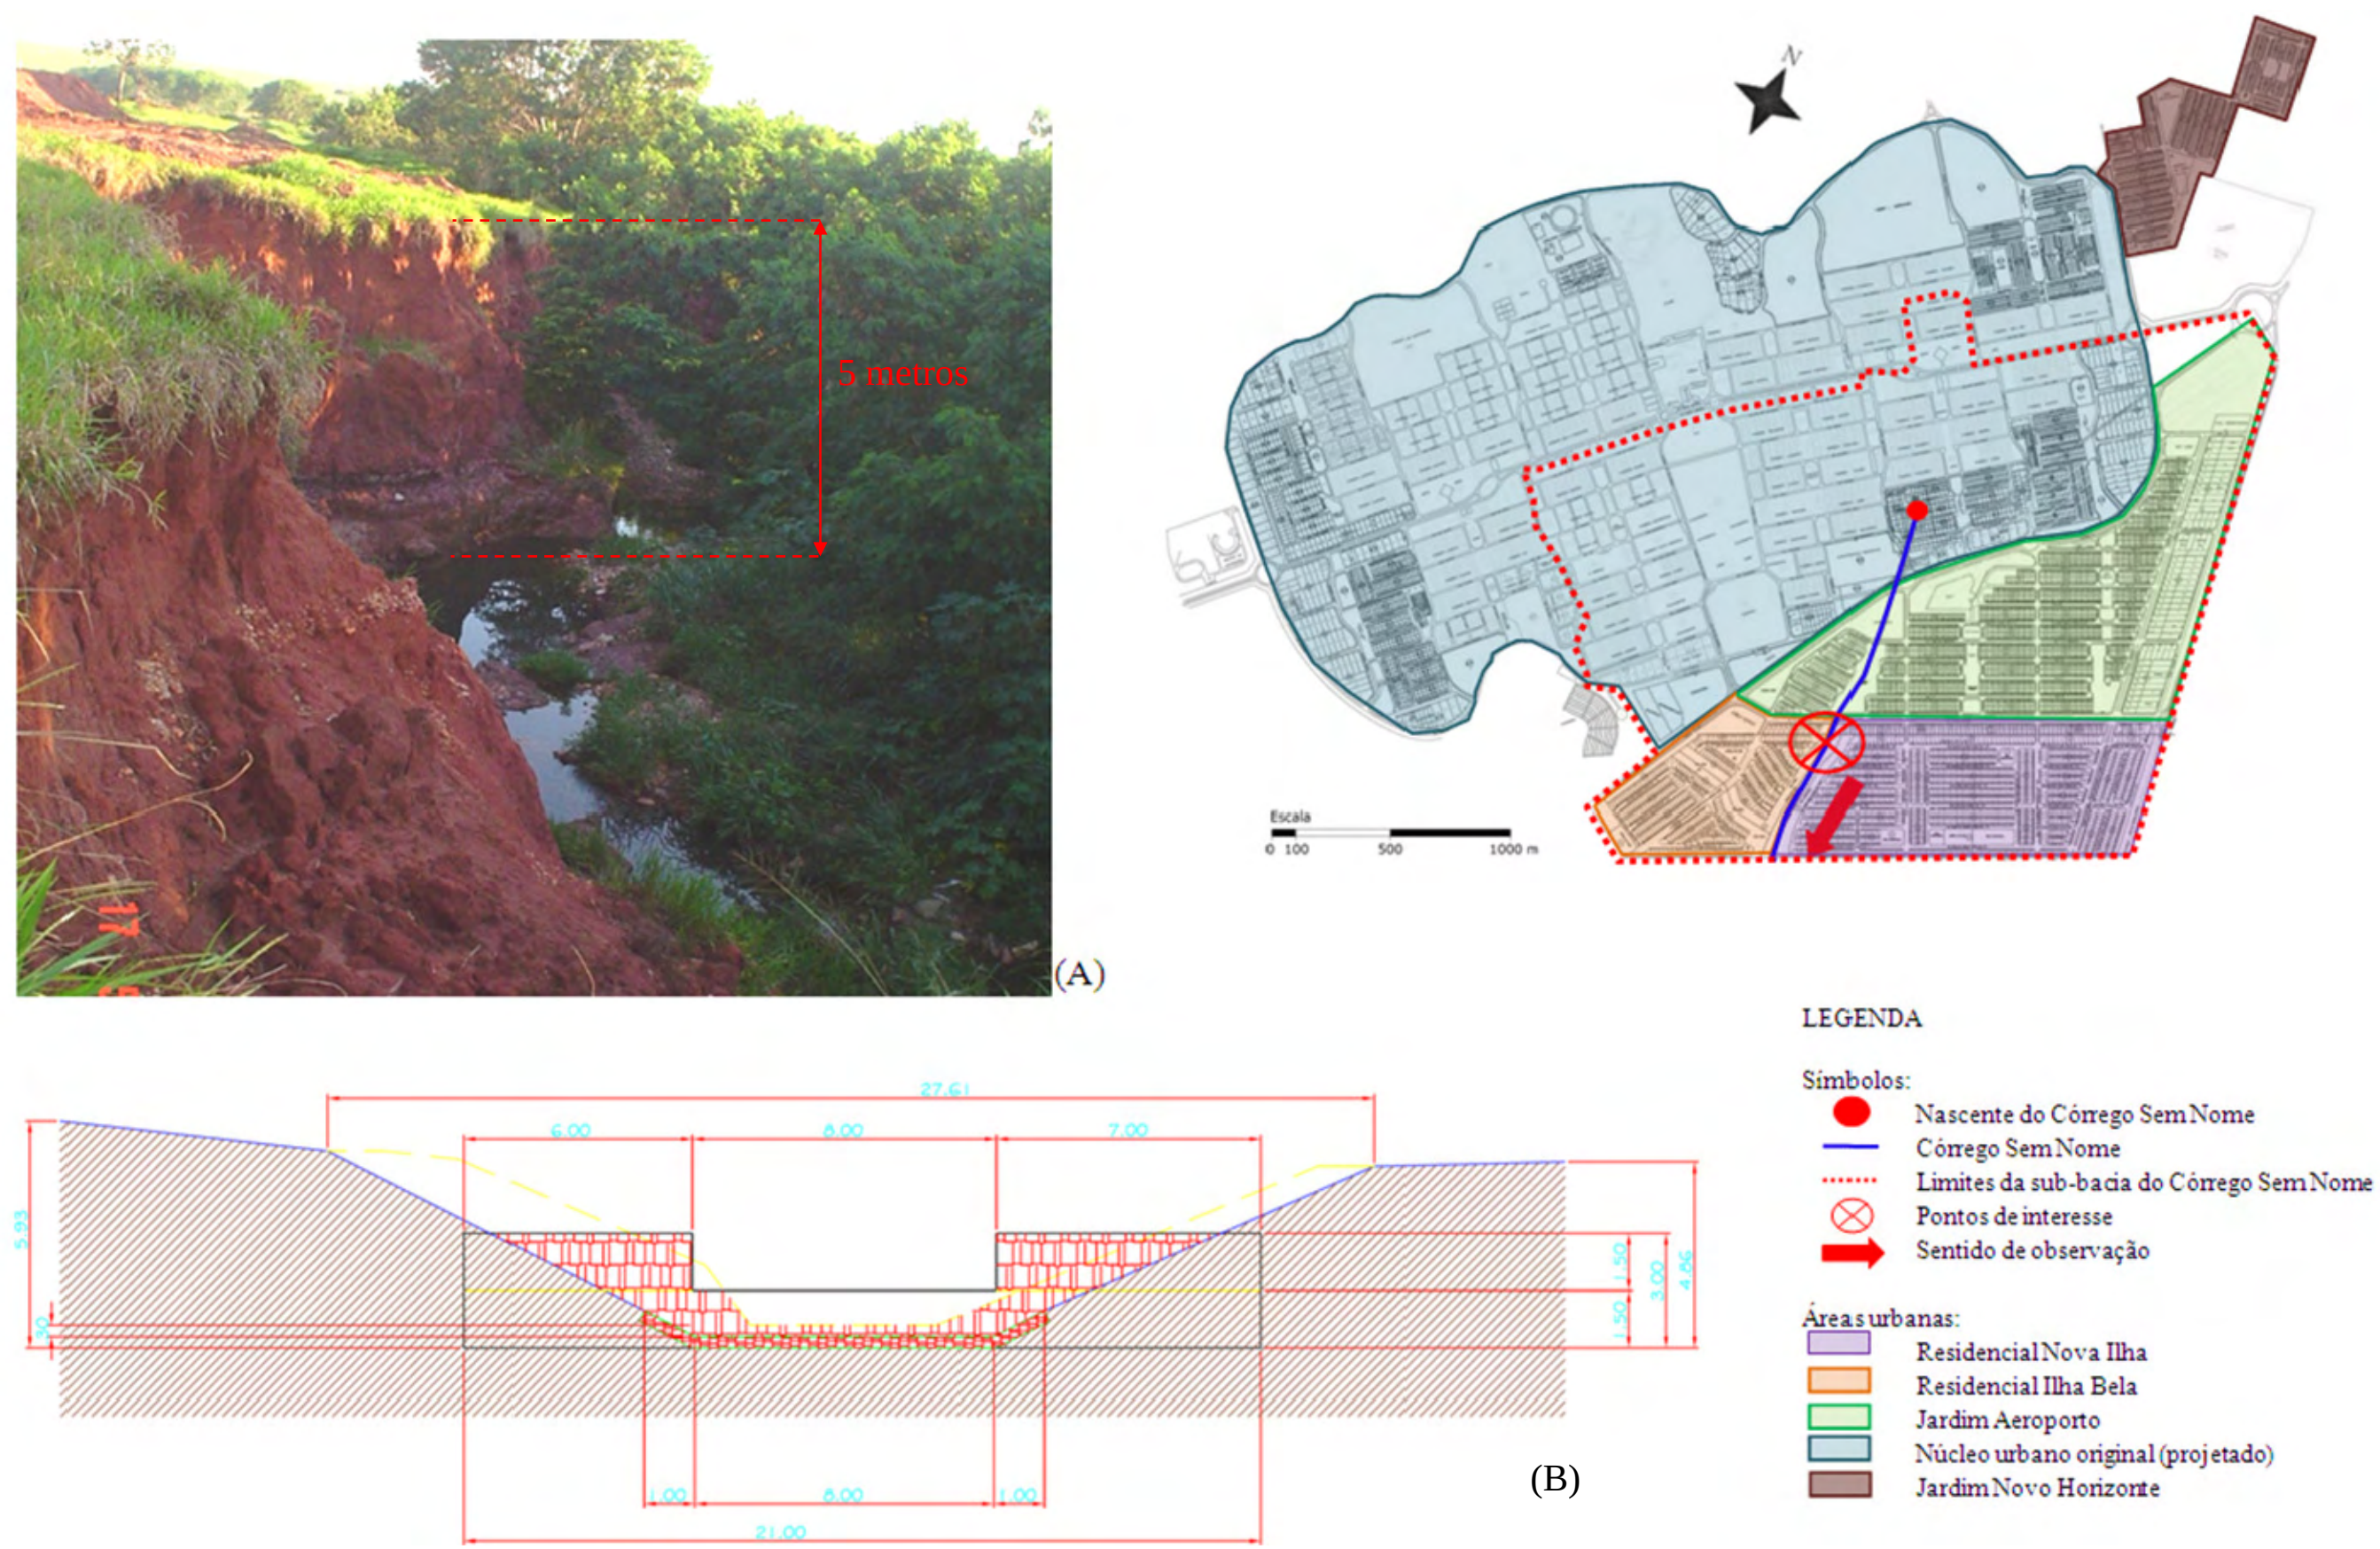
Trecho 4 detalhe da erosão (A) e seção proposta no projeto de canalização não implantado (B) (Fonte: (A) arquivo pessoal Thiago Santim, 16/05/2008 e (B) Ilha Solteira, 2007)
